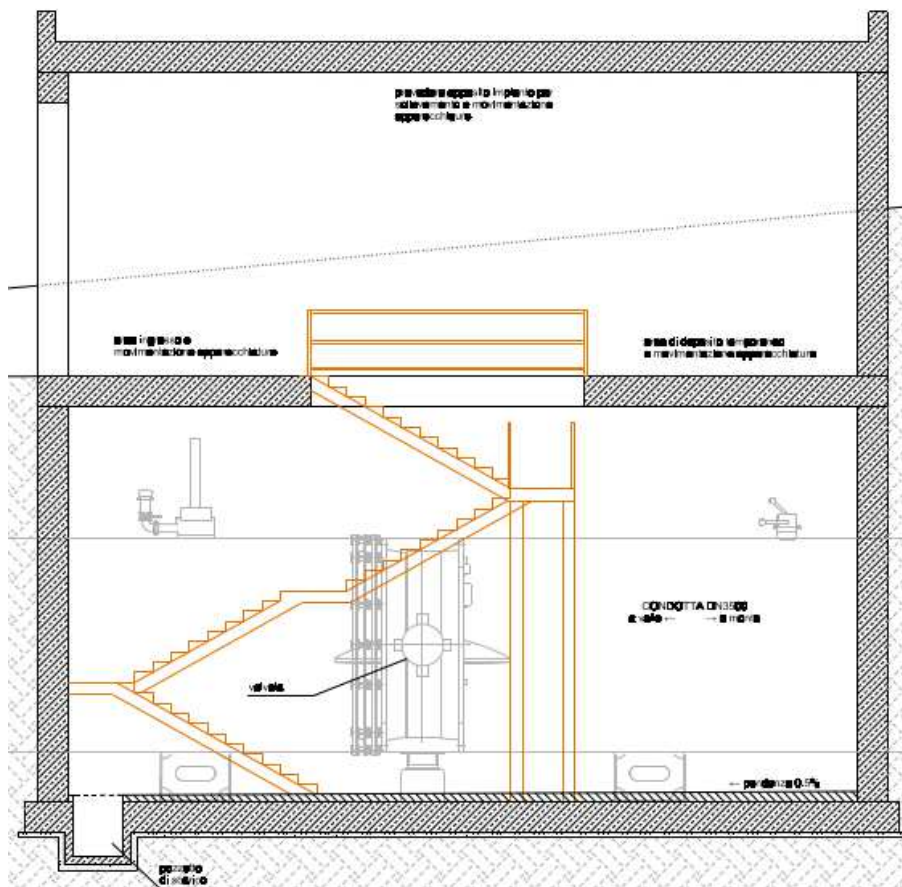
Sezione dell'edificio di servizio (estratto Tav. PD-EP.20.4).
